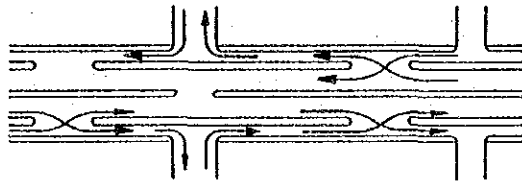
PLANO TÍPICO DE LAS APERTURAS DEL PASEO CENTRAL
